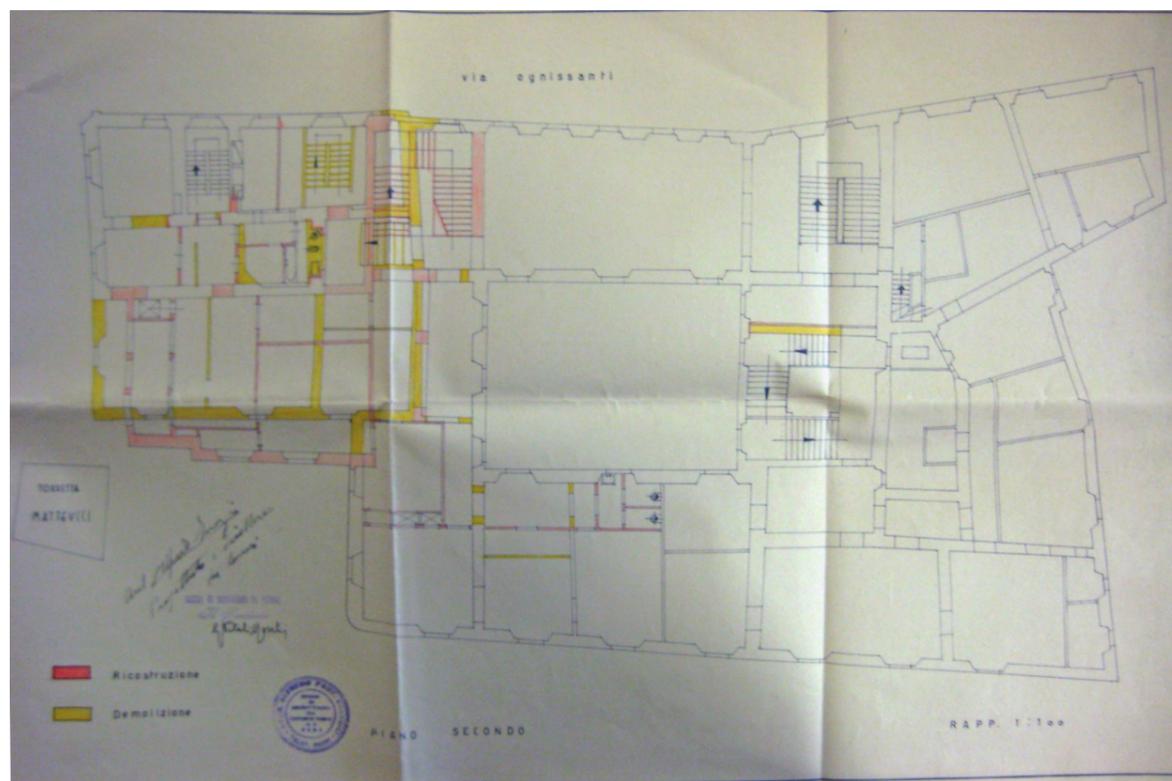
Pianta del piano secondo. Progetto dell'architetto Alfredo Energici. Archivio della Cassa di Risparmio.
